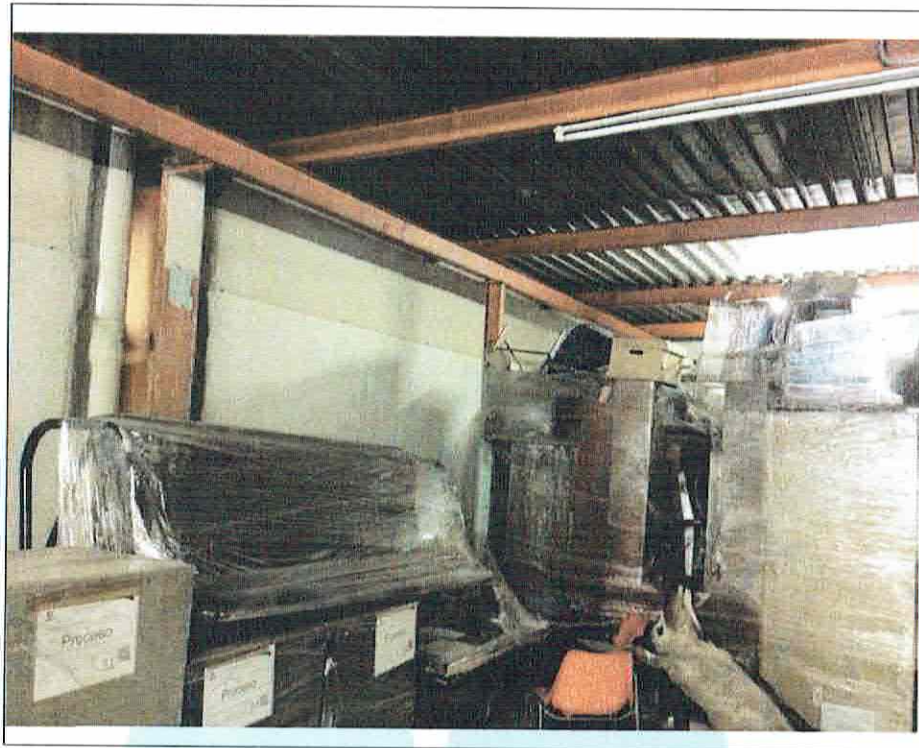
En la imagen se muestra la configuración de las estructuras secundarias dentro de las bodegas.
